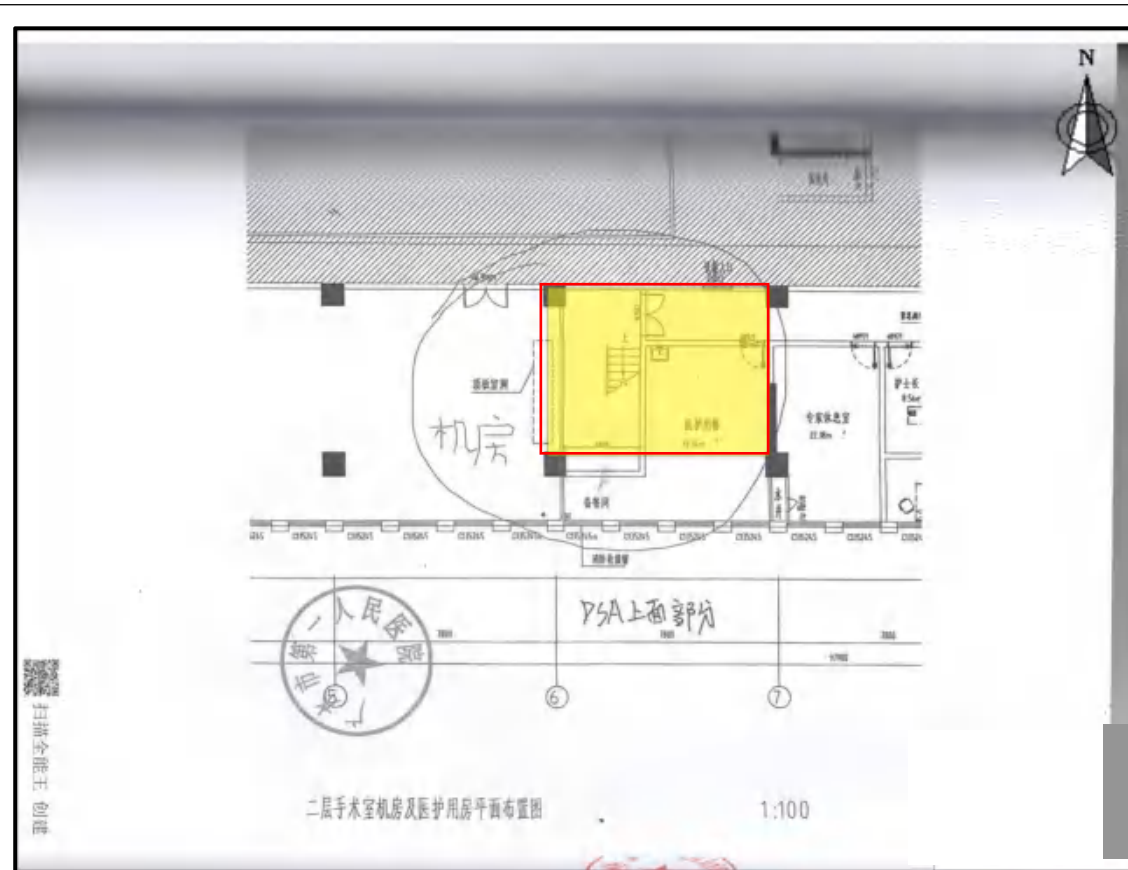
急诊外科楼一层 DSA 机房上方平面布置图
